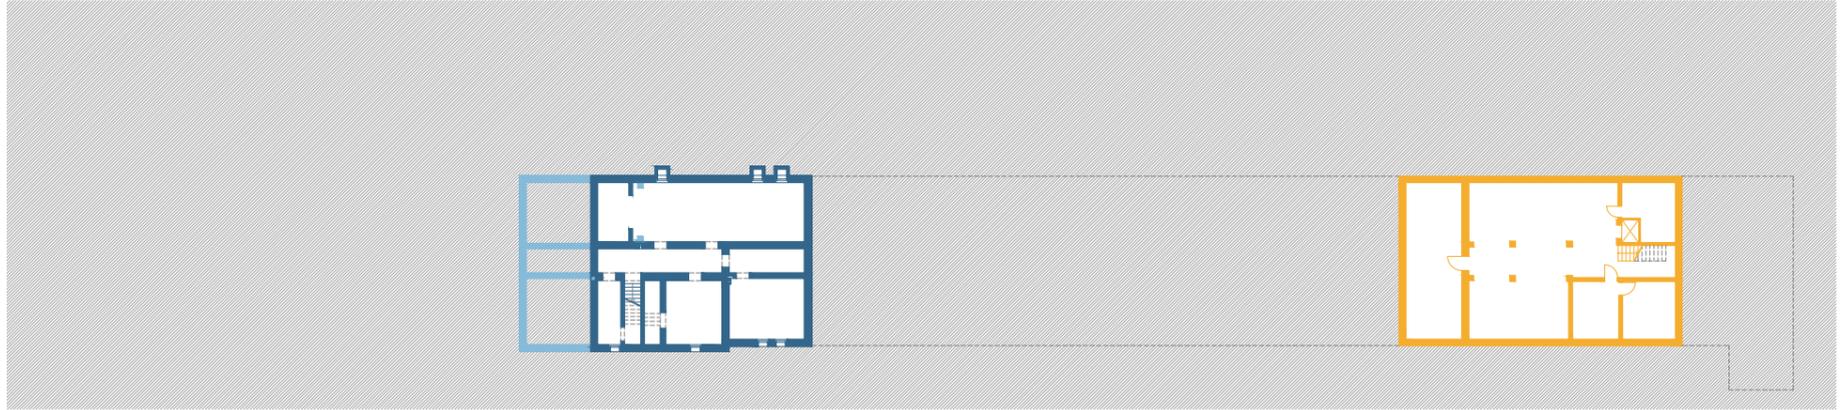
Baualtersplan: Zollamt und Zollschuppen, Kellergeschoss, 2022 M1:500
